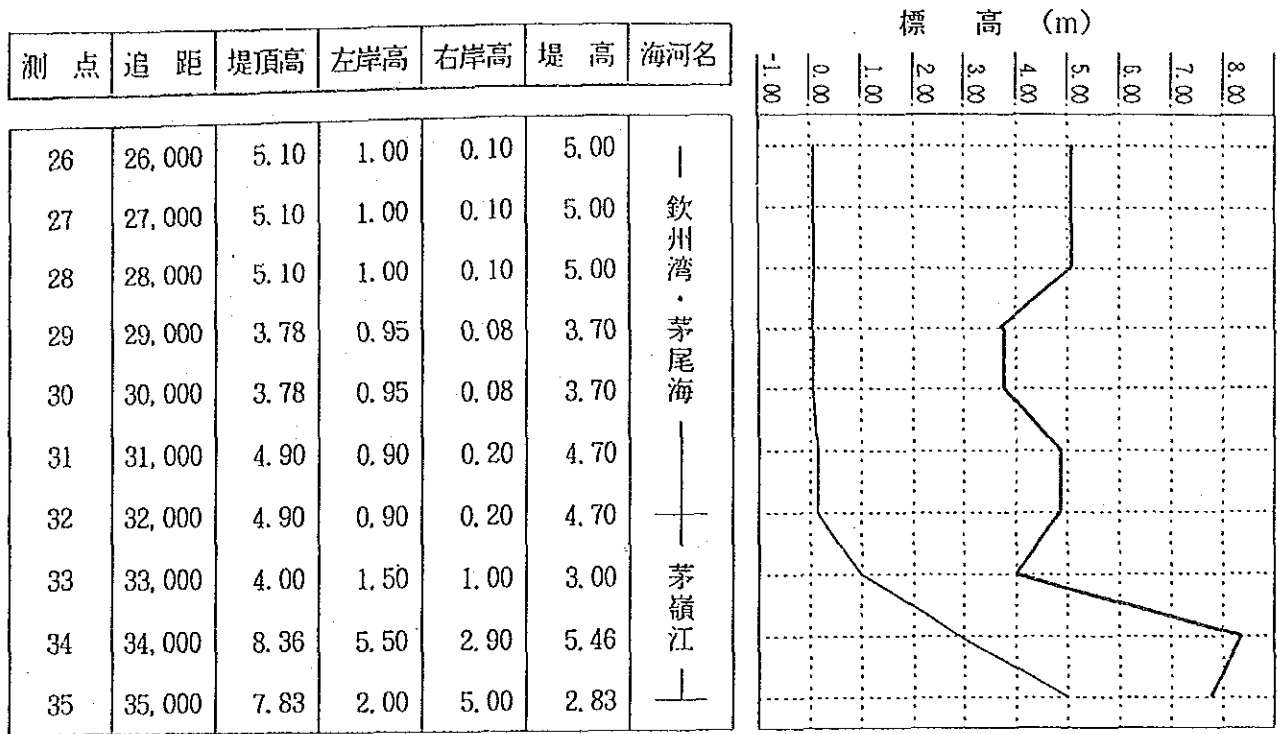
鳳凰嶺団海河堤系縦断面図 (その2/2)
